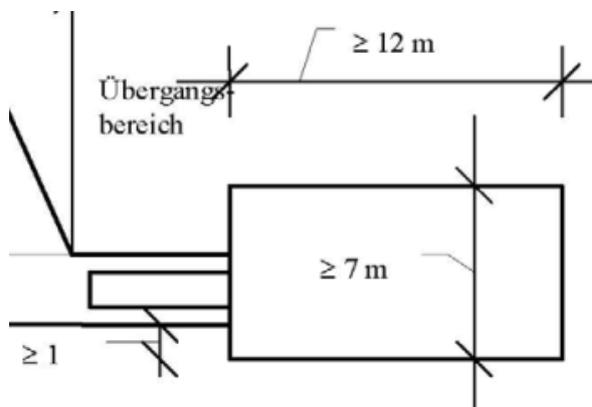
Ausführung Bewegungsflächen auf den Grundstücken, MRFIFw [12]
